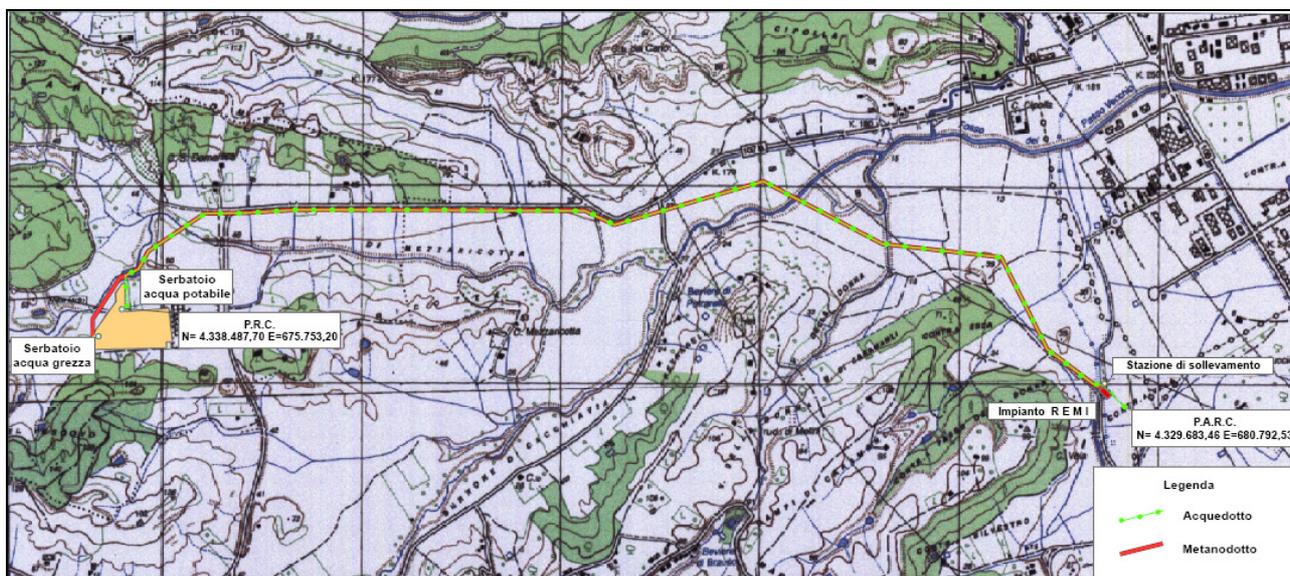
Planimetria dei tracciati dell’acquedotto e del metanodotto.
